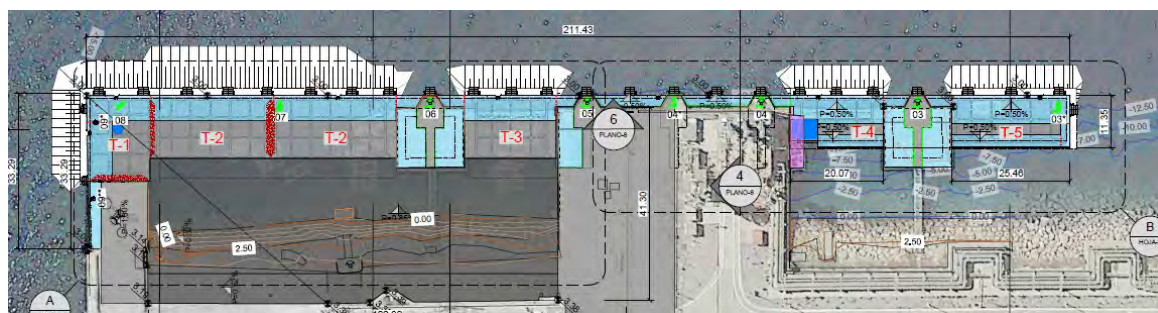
Esquema en planta de la obra. Fuente: SATO (2020)
